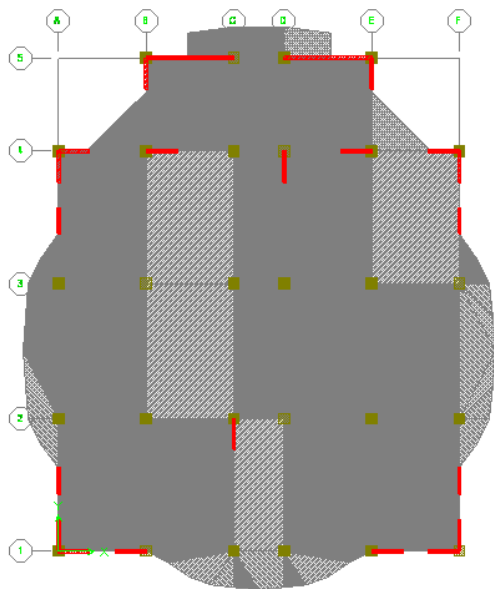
Vue en plan de l'étage 2 et 8.
